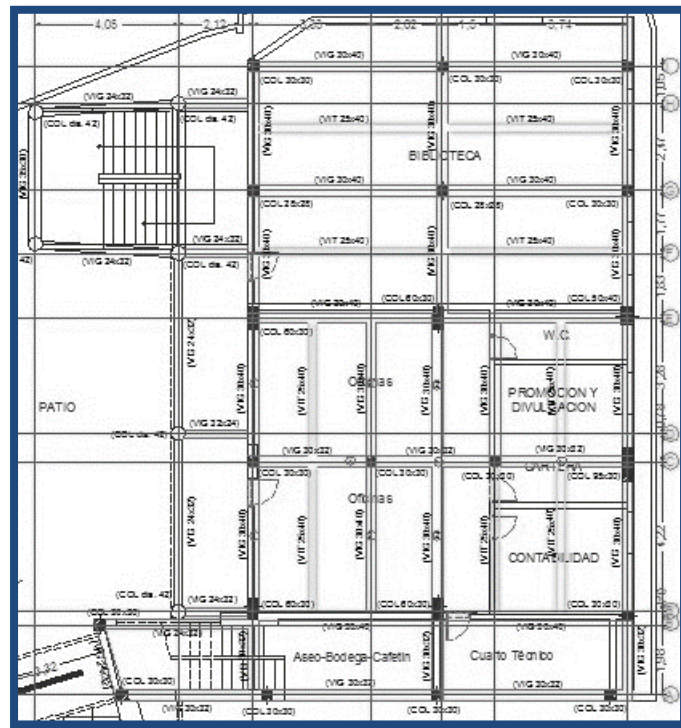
Planta estructural edificio #2. Fuente: Levantamiento estructural
